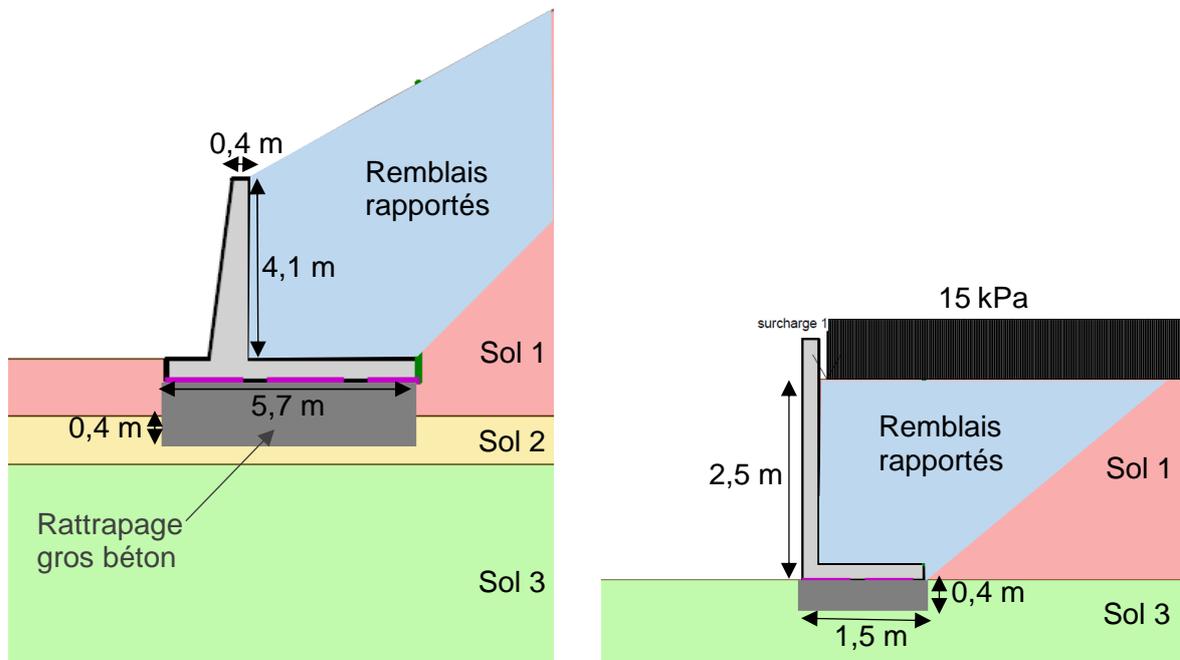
Mur n°2 (gauche) et mur n°5 (droite)
